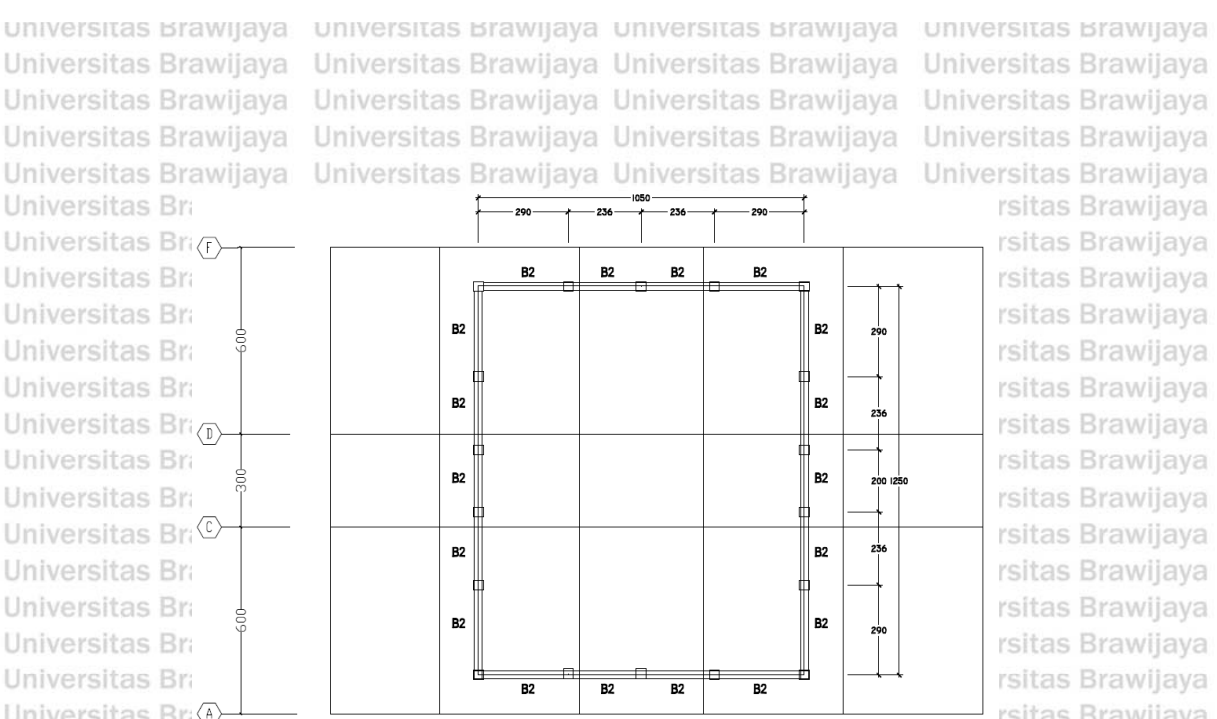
Denah Balok Lantai 3 dan 4.
